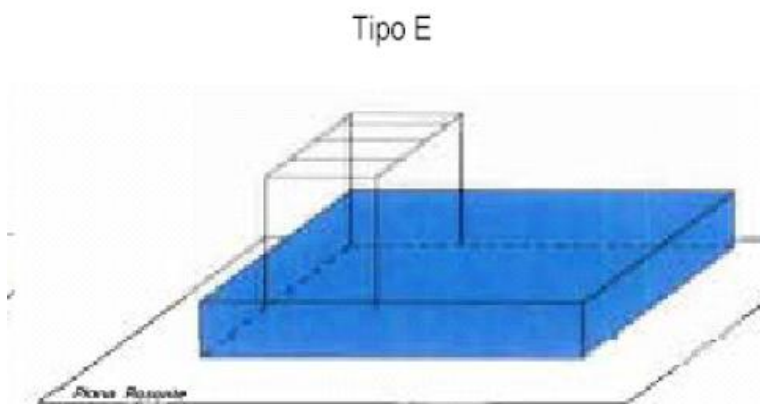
Tipo de industria que corresponde con la planta de compostaje.
